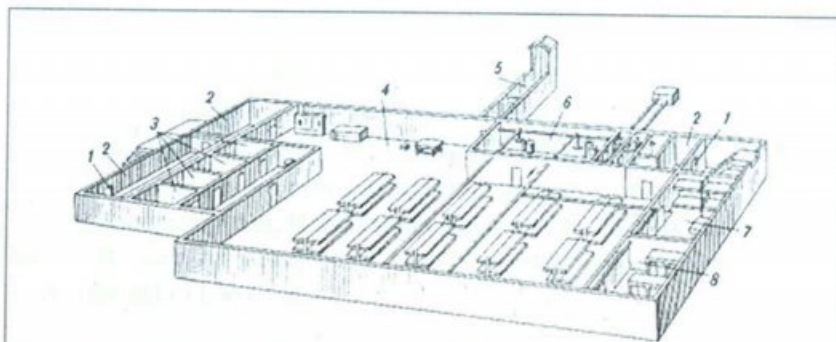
План убежища: 1 - защитно-герметические двери; 2 - шлюзовые камеры (тамбуры); 3 - санитарно-бытовые отсеки; 4 - основное помещение для размещения людей; 5 - галерея и оголовок аварийного выхода; 6 - фильтровентиляционная камера; 7 - кладовая для продуктов питания; 8 - медицинская комната (помещения 7 и 8 могут не устраиваться).
